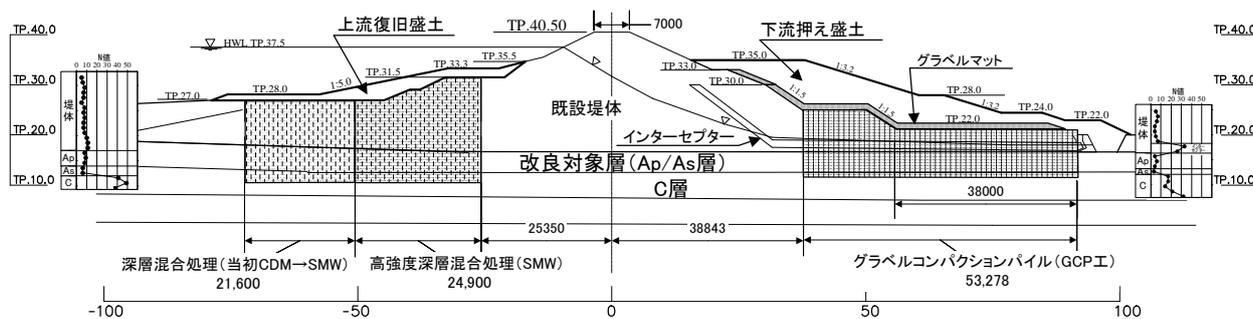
山倉ダム第一堰堤強化工事標準断面図 (2-9)
